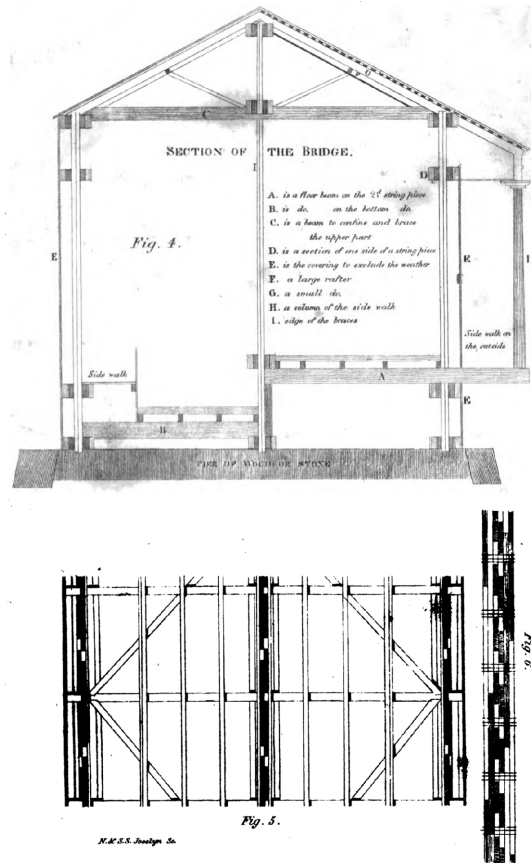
Sistema Town. Sezione trasversale e schema di impalcato.
